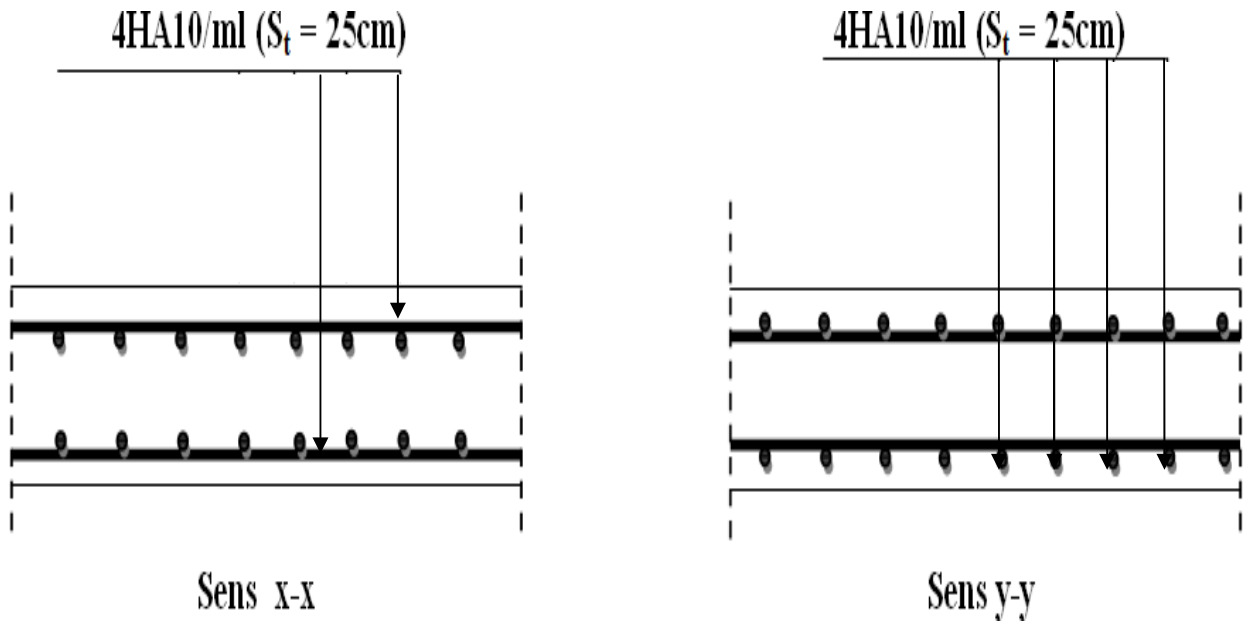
Ferrailage de la dalle pleine de la salle machine.
